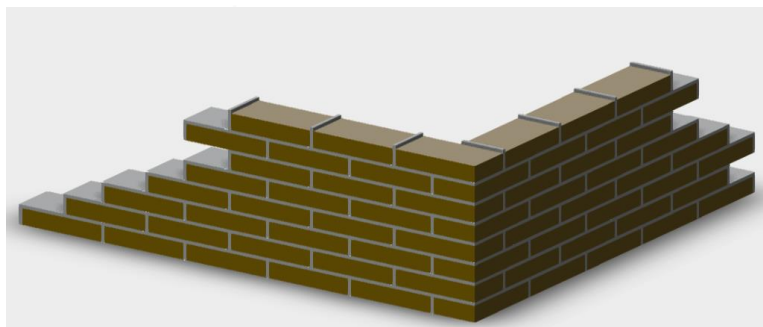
Detalle de construcción del muro de mampostería de ladrillo Antiguo.
